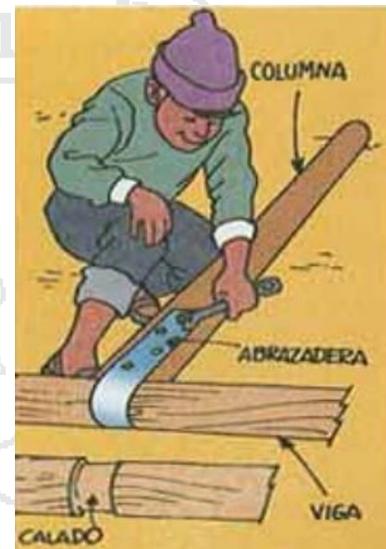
Detalle de anclaje de columna y Tijeral.
